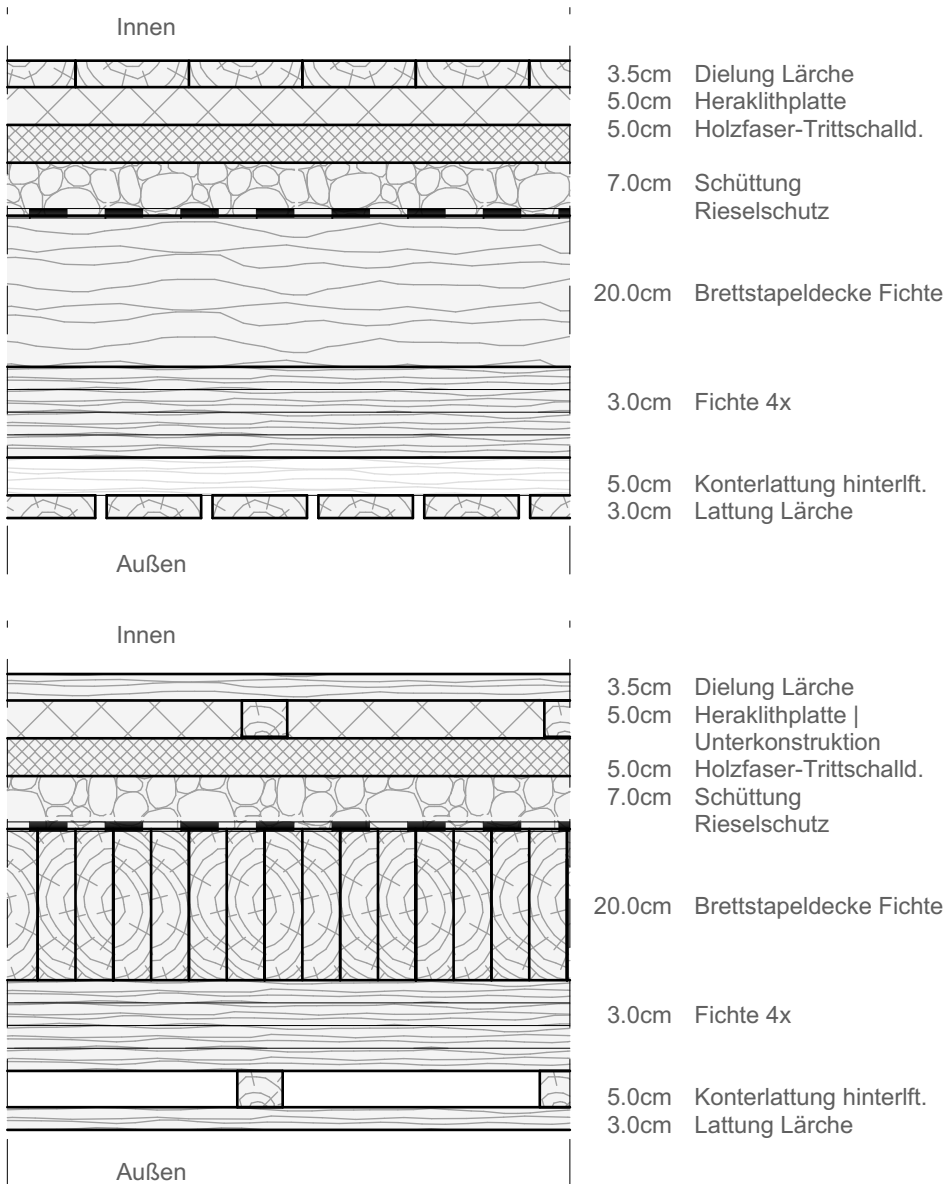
Annahme Decke gegen Außenraum - Detail M 1:10
